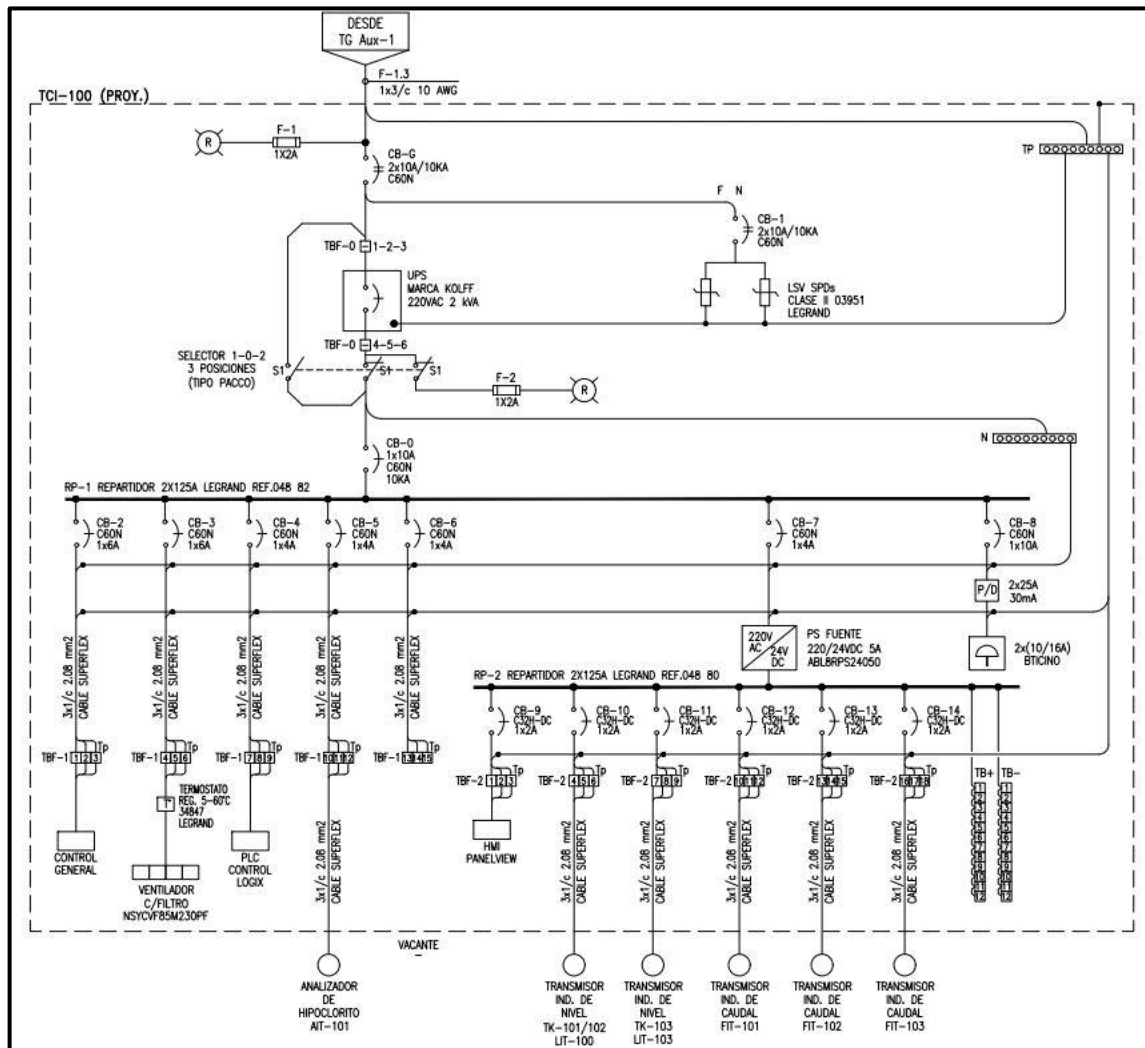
Plano Unilineal TCI-100. Extracto de plano TC-6-R1\_Talagante [7]
